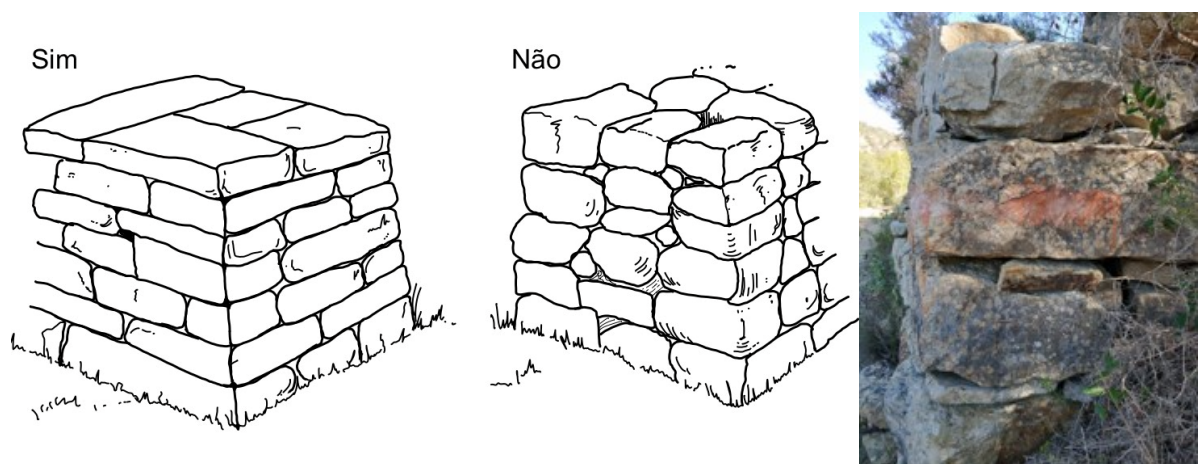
Esquerda: Construção do canto do muro. Fonte: Elaboração própria baseada em Carlos *et al.*, 2021; Direita: Fotografia representativa da construção, na zona em estudo, Canal do Poço, Santa Bárbara de Nexe. Fonte: Elisa da Silva, 2020
